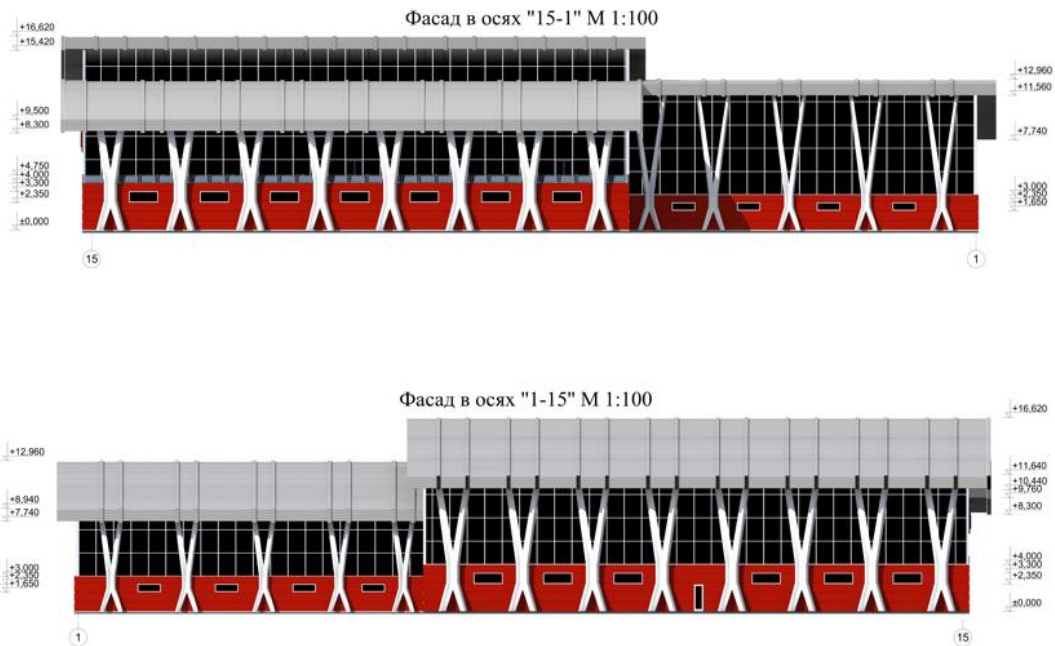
Фасад будівлі спортивного комплексу: а) фасад в осях 15-1; б) фасад в осях 1-15.
